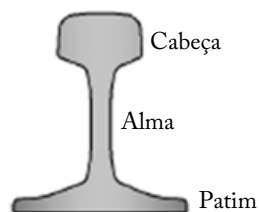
Perfil de carril do tipo Vignole, adaptado (Tzanakakis, 2013)
